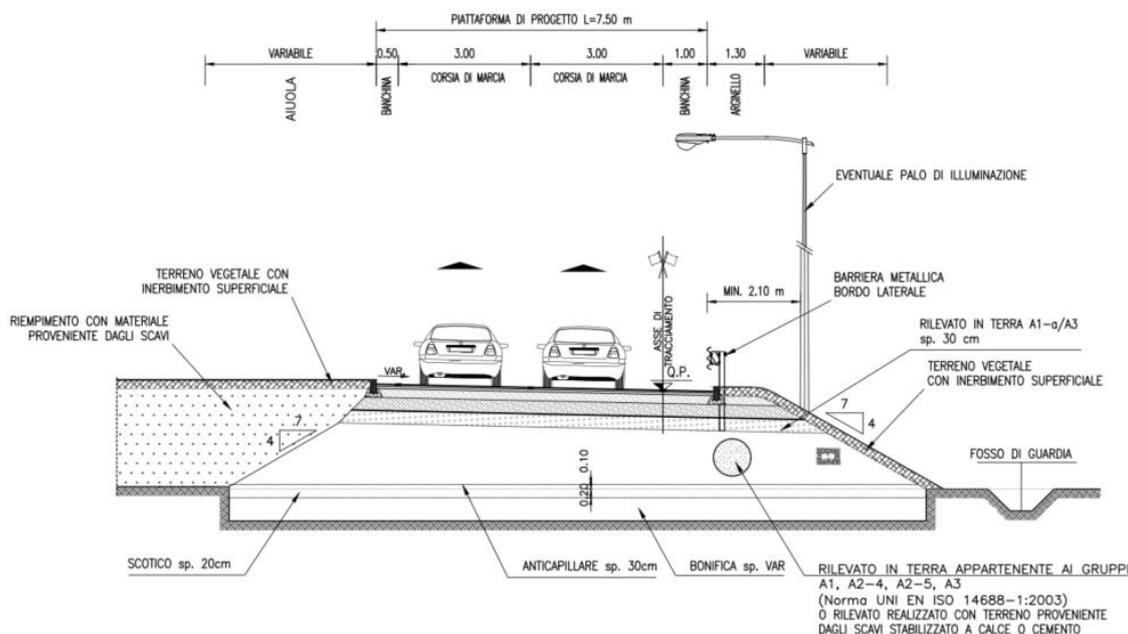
Sezione tipo ramo di ingresso a doppia corsia
